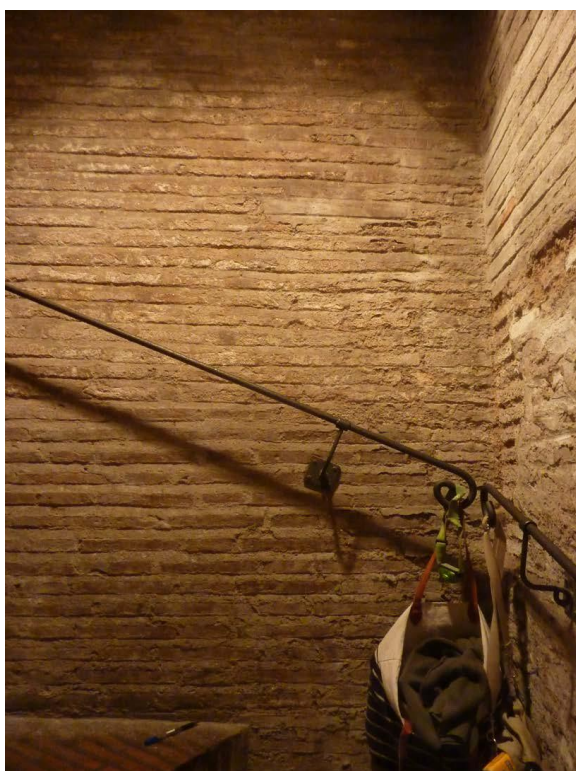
Prospetto SS2e. Foto D'Ippolito.
